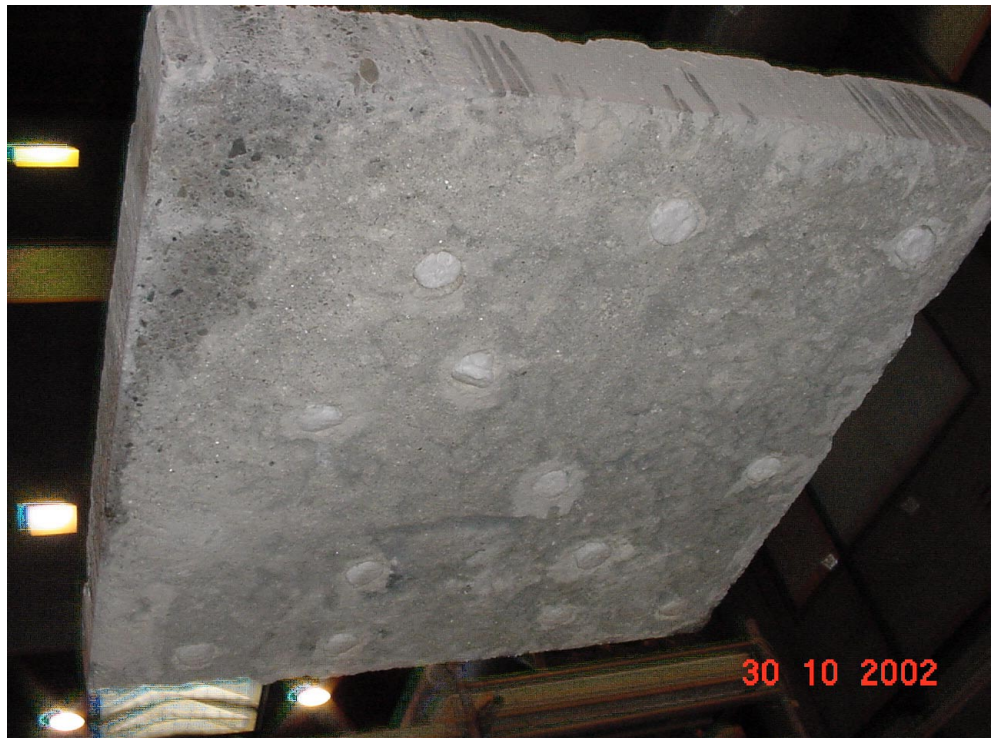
Betonplaat vanaf verhitte zijde na opvullen gaten
